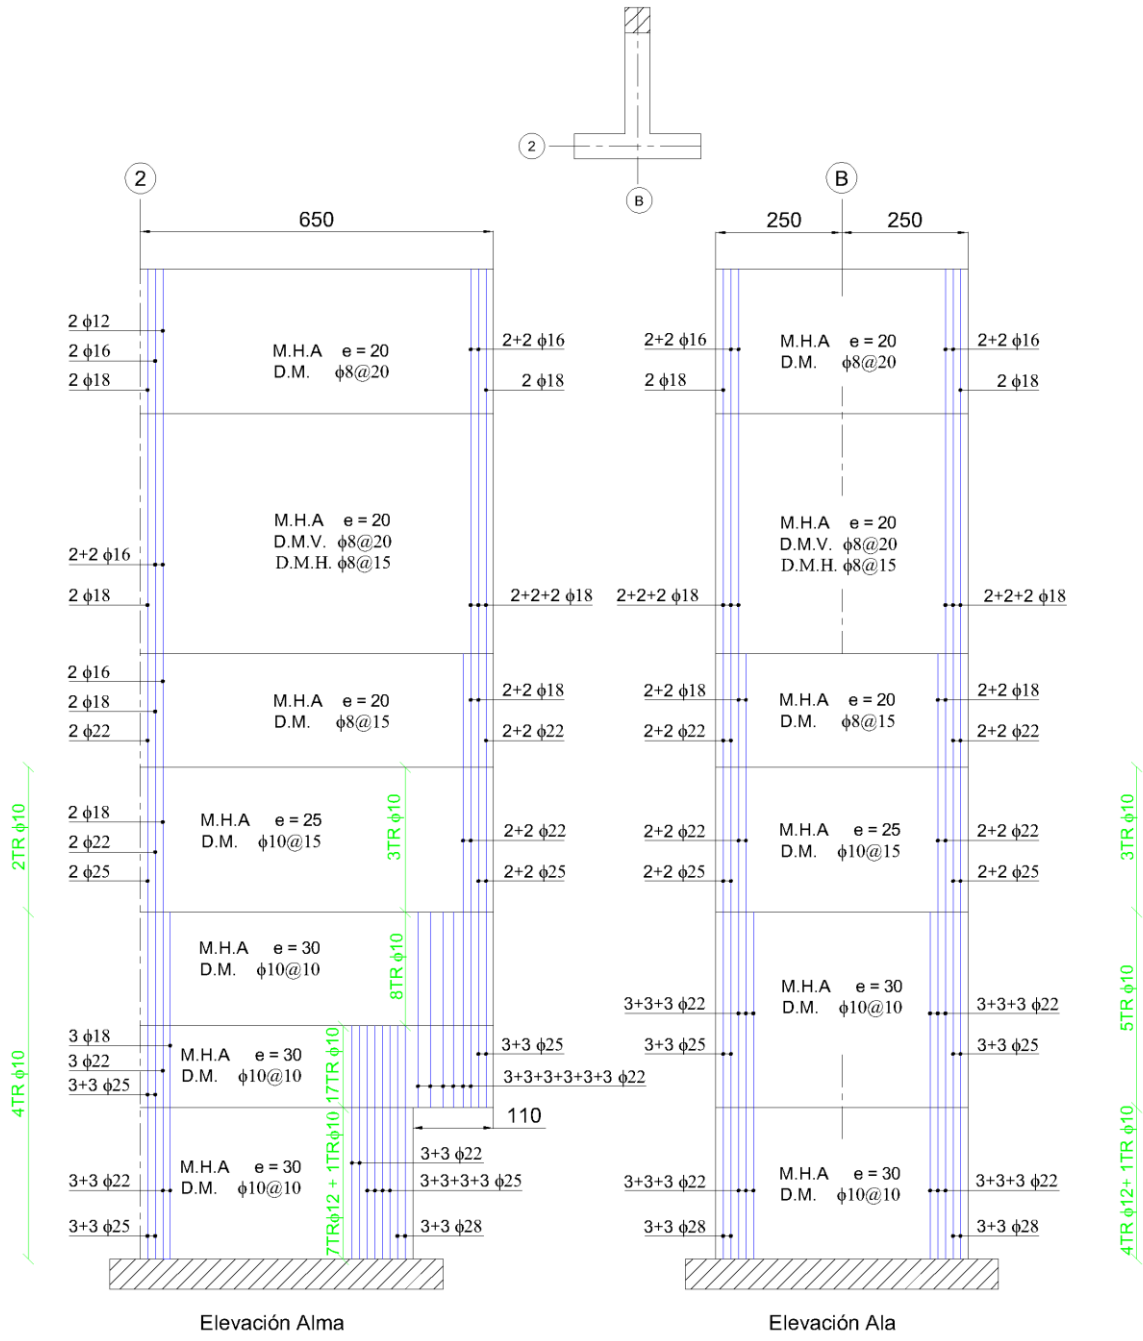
Plano (con vista en elevación) del muro MT2.
